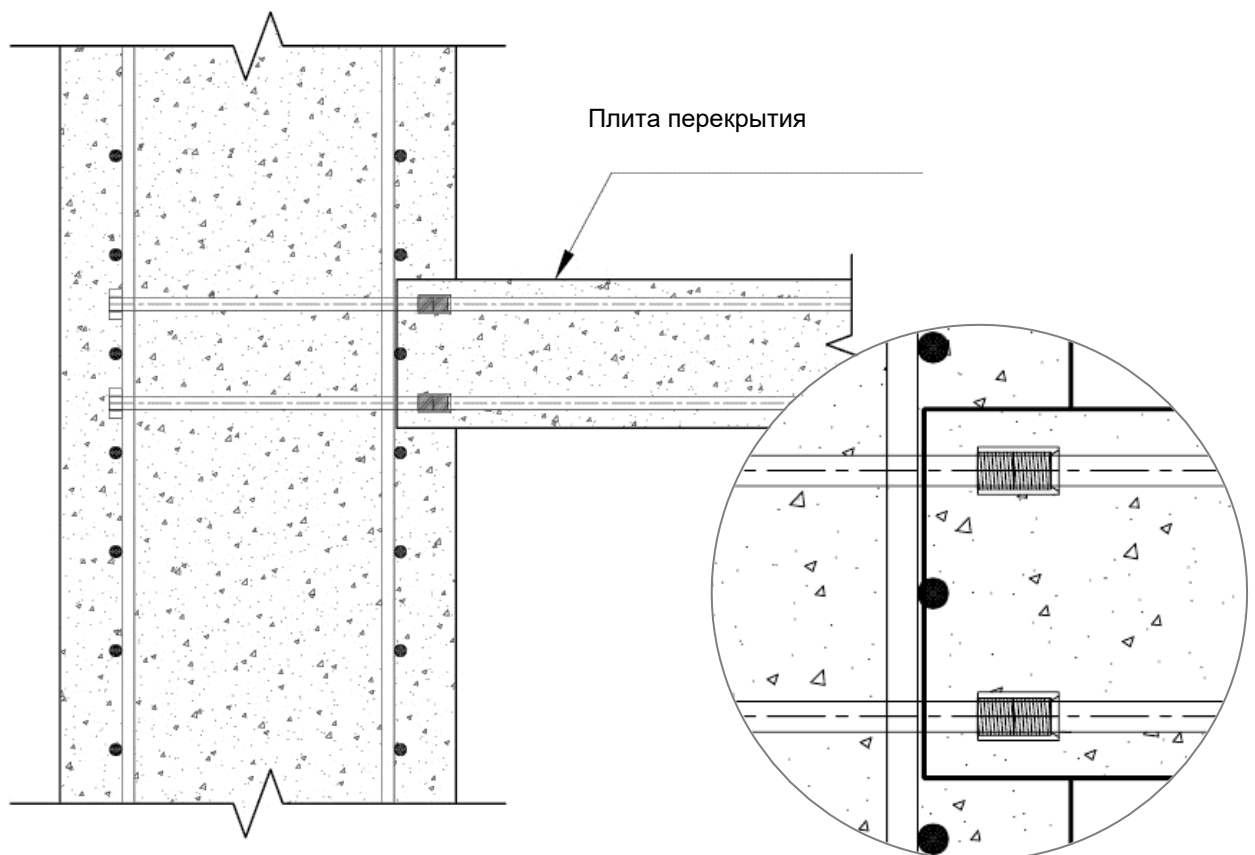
Бетонирование плиты перекрытия
